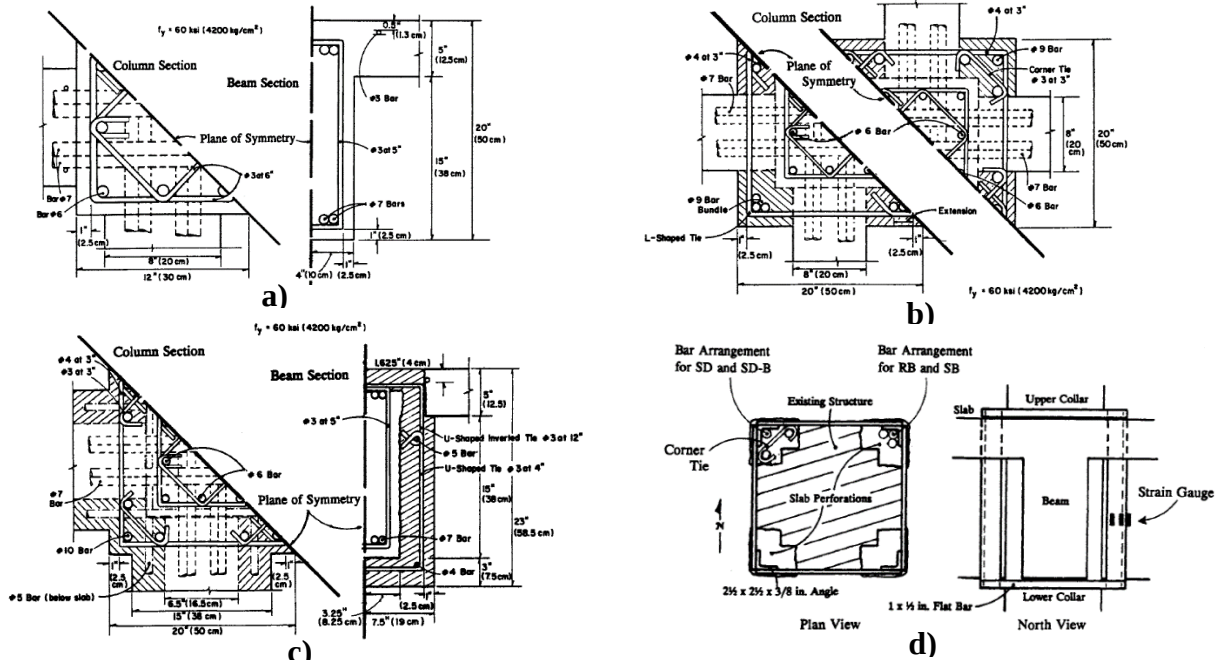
Encamisado de columnas; a) espécimen original (O), b) especímenes RB, SB y SD, c) espécimen SD-B y d) perforación y configuración de refuerzos en los nodos, adaptado de Jirsa y Alcocer (1993).
